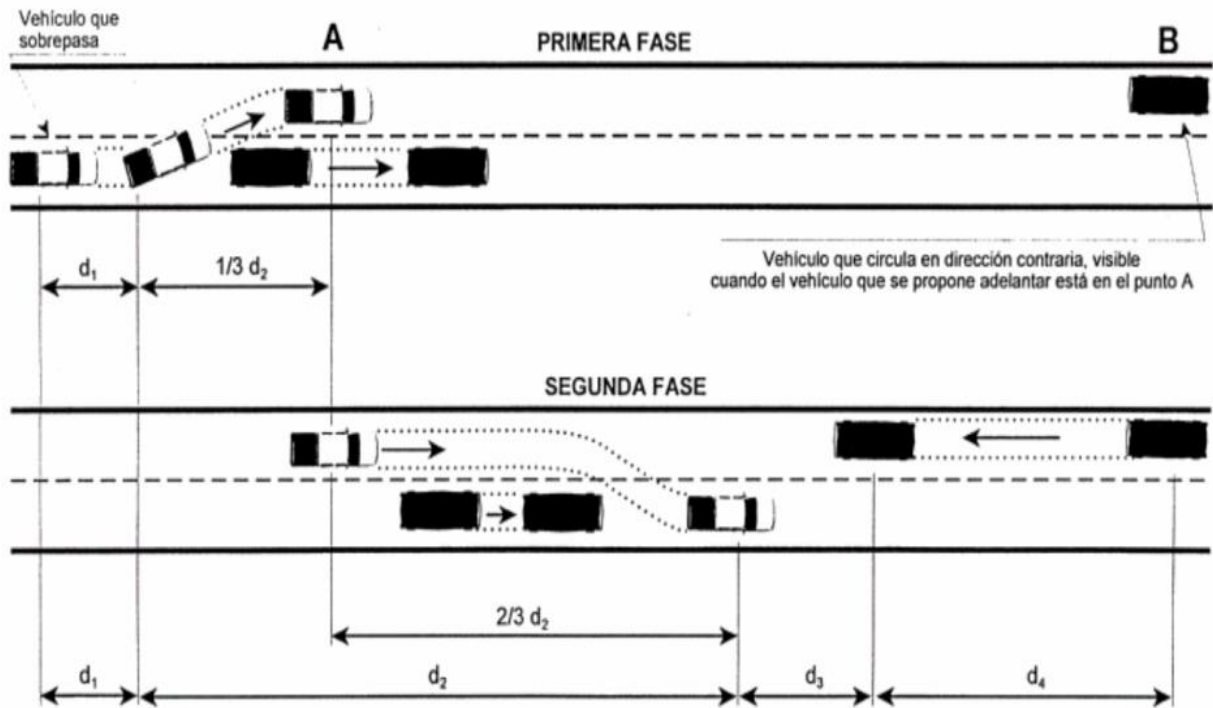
A.204- 02 Etapas de la maniobra para adelantamiento en carreteras de dos carriles
